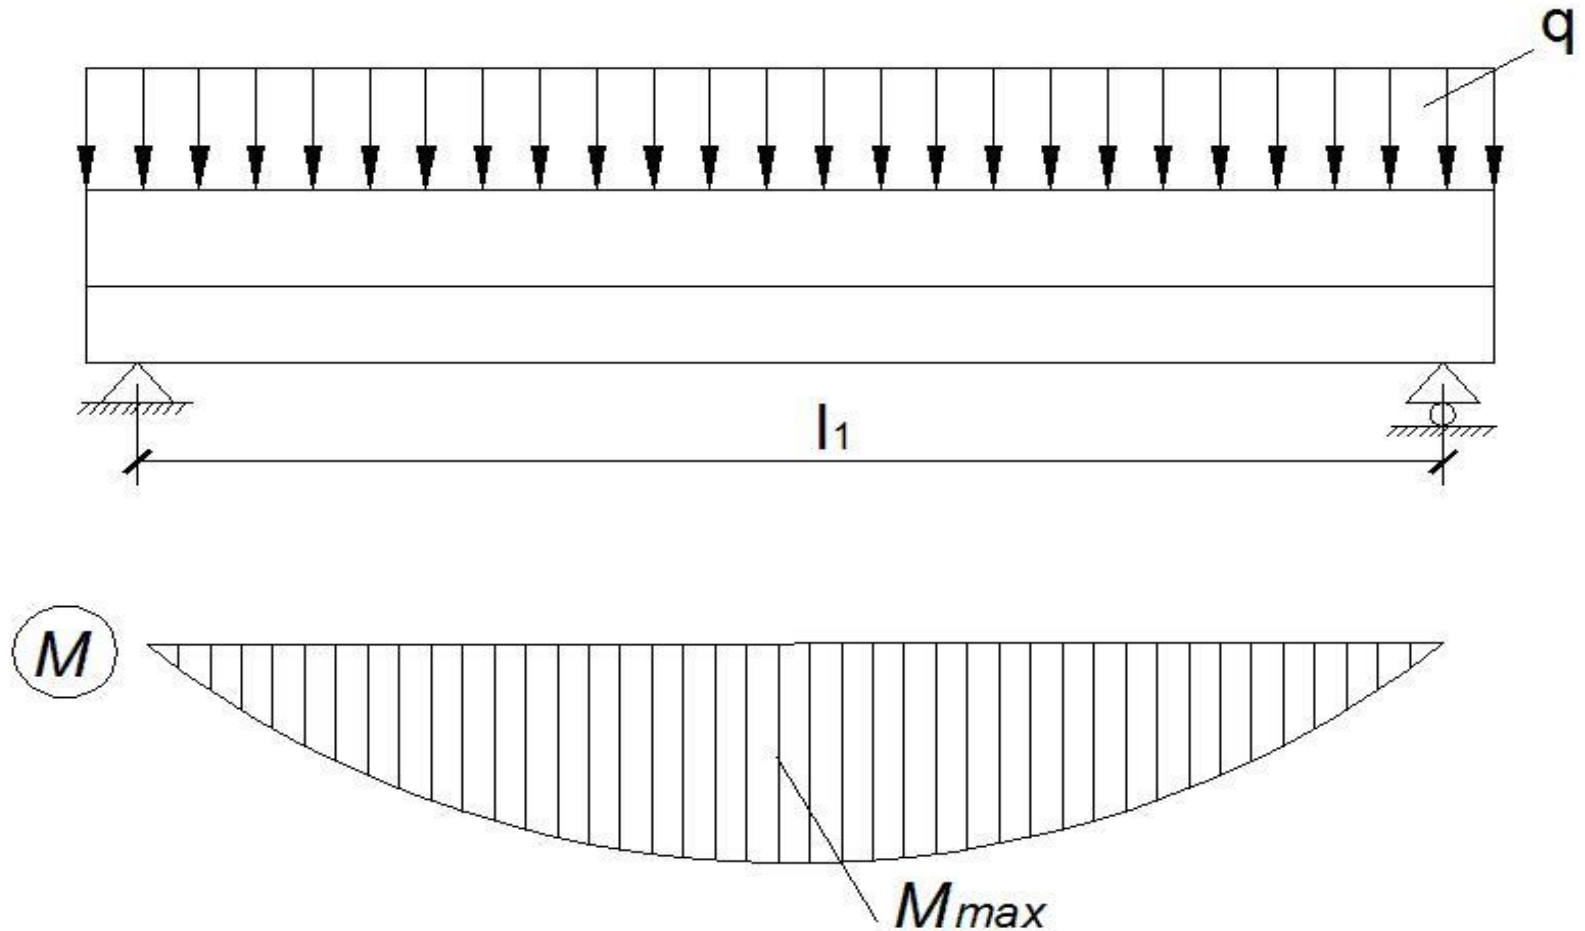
Конструктивная схема монолитной короткой цилиндрической оболочки
